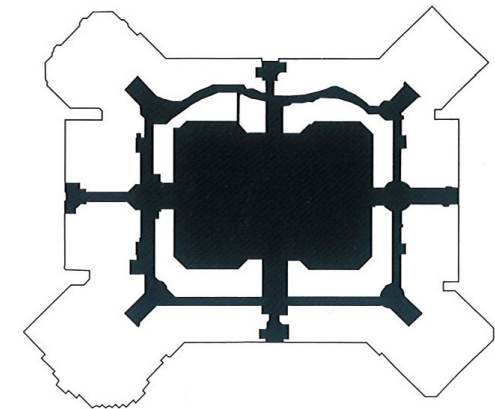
Mall of America, Grundriss Schemata, Arch. Jon Jerde
